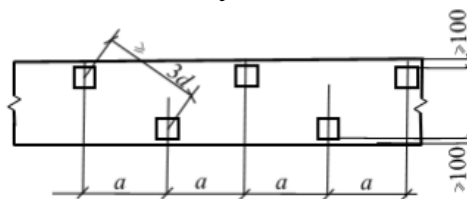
Схема расположения свай в рядовом фундаменте
